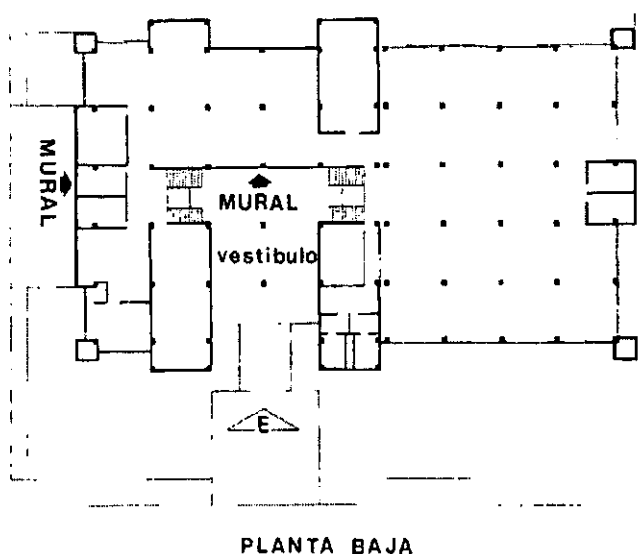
Biblioteca Central, planta esquemática (AOV).
